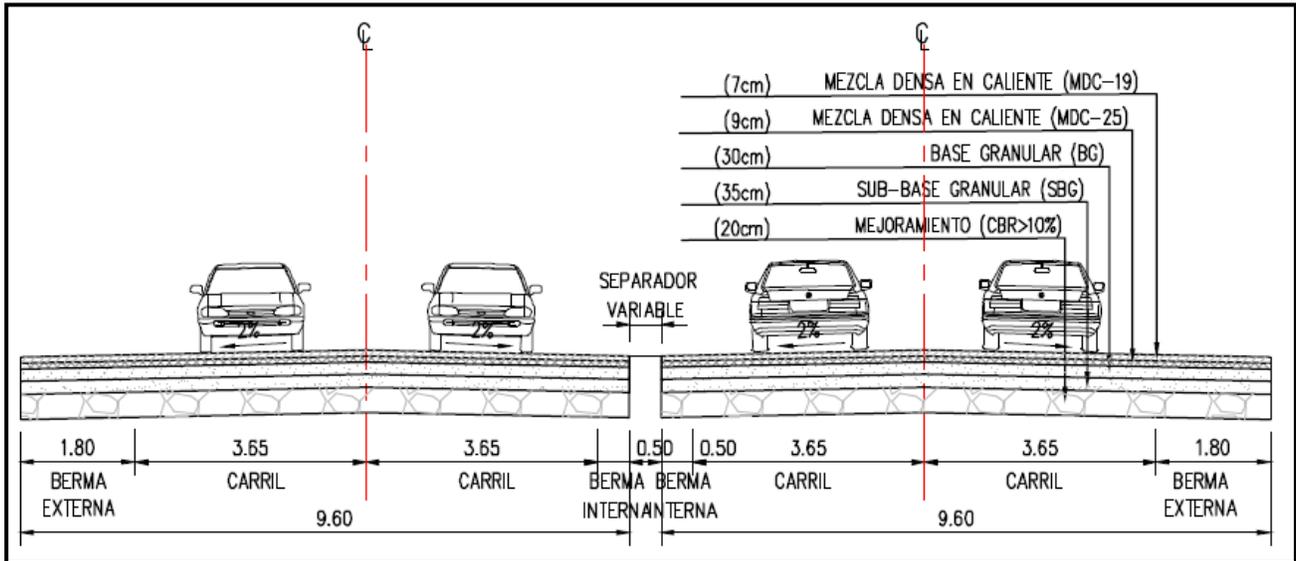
Sección de la Vía Típica – Doble Calzada (Para tramos con calzada existente)
